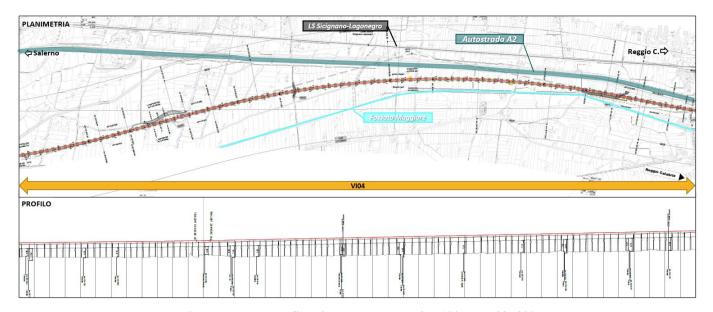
Planoprofilo di progetto da km 35+100 a km 39+300
